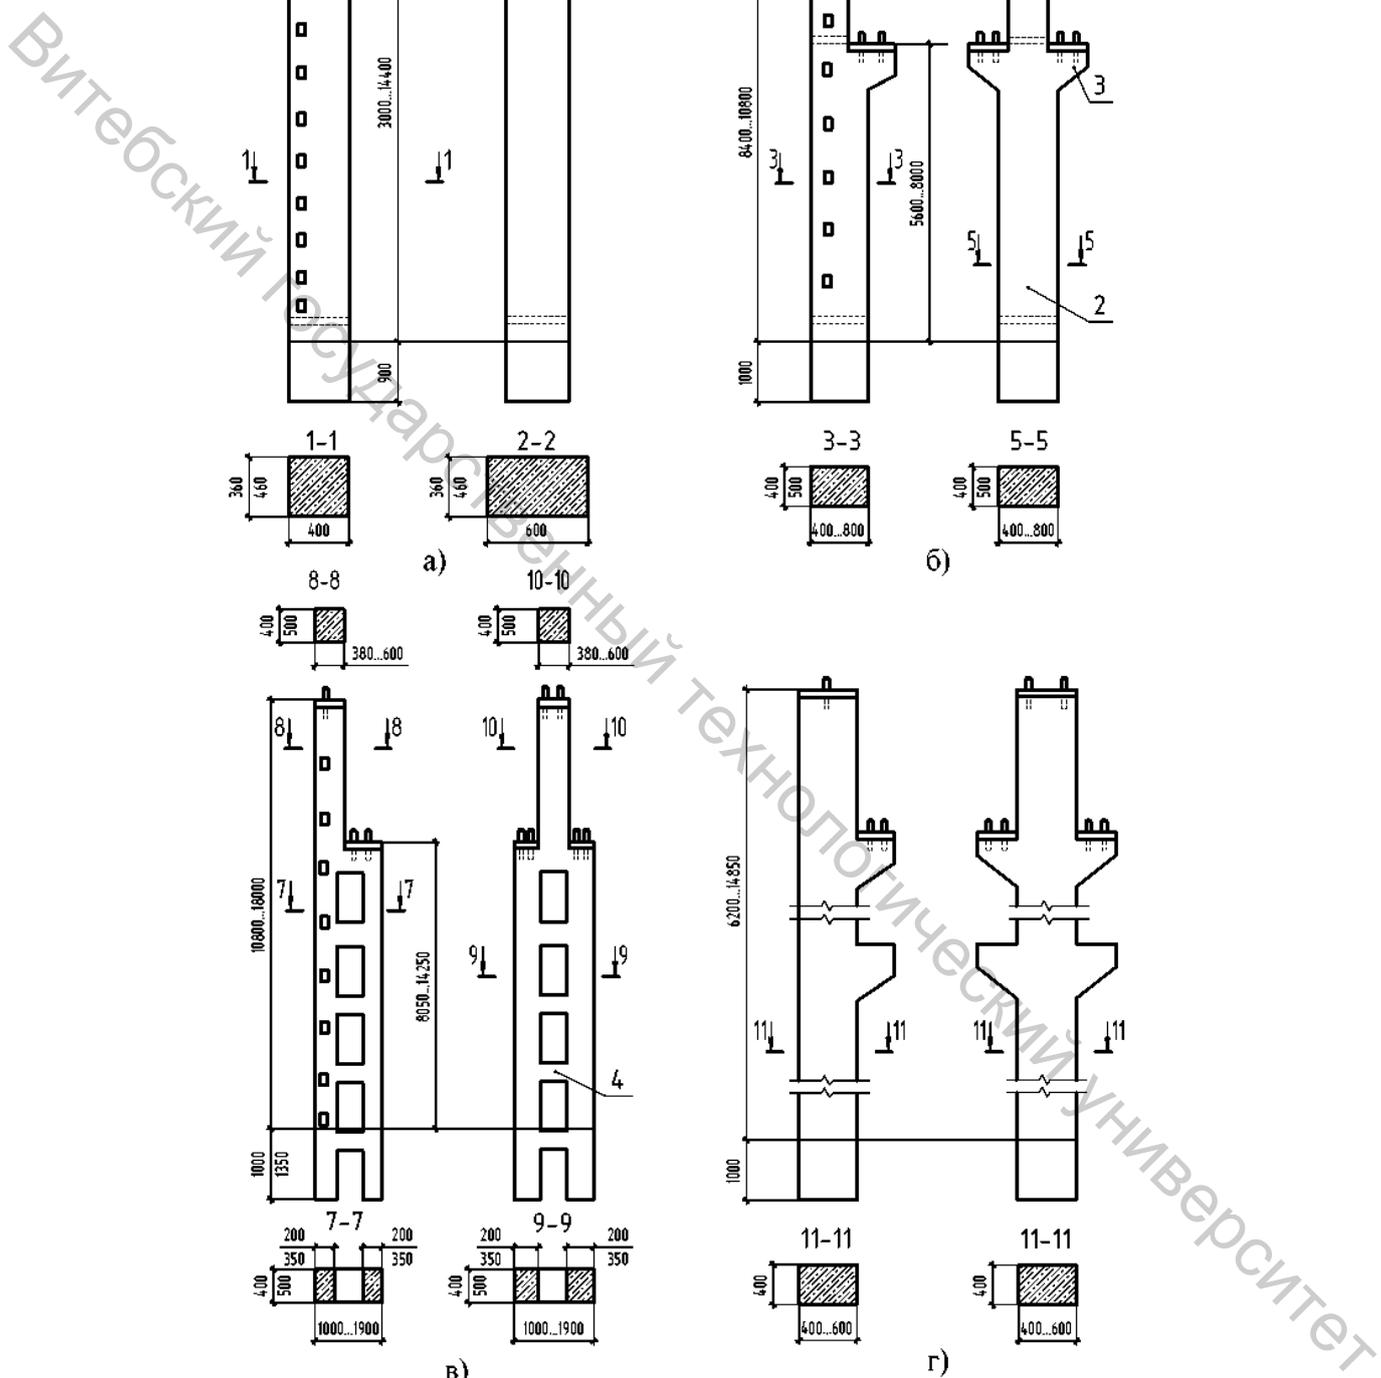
(а, б, в, г) – Типы железобетонных колонн промышленных зданий:
